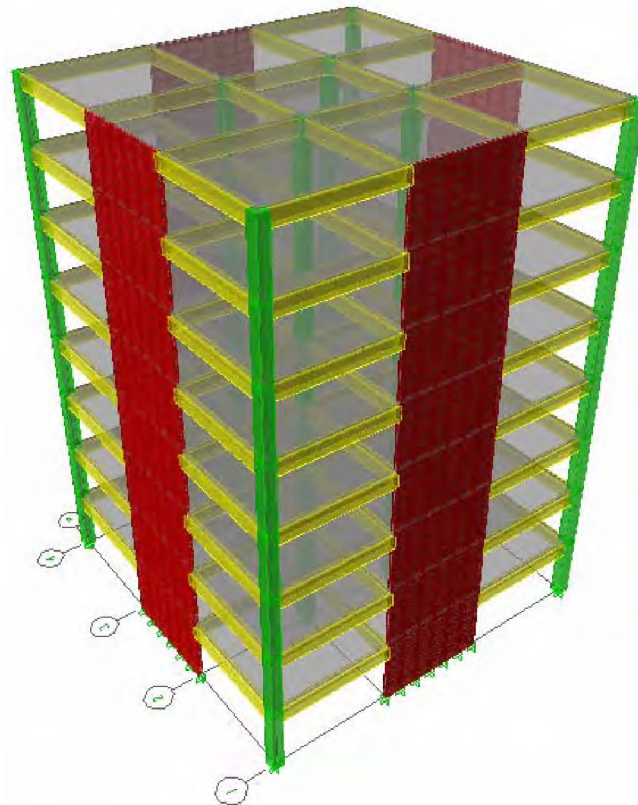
Modelo tridimensional de la edificación de ocho niveles con muros estructurales.
